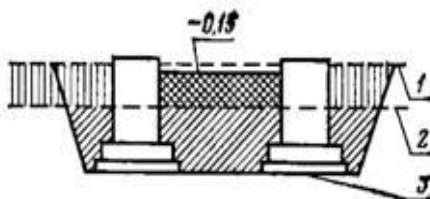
Схема разработки котлована с распределением доли грунта, относимой к различным сметам, когда на площадке предусмотрена подсыпка грунта:
